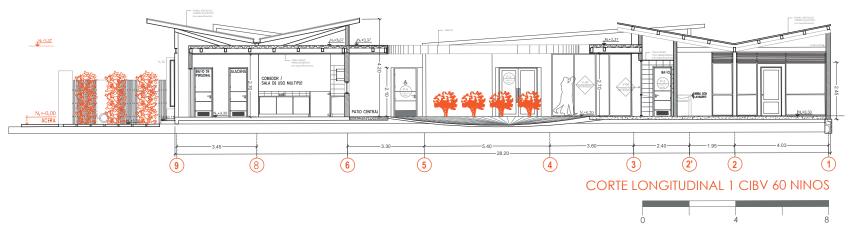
Corte Longitudinal CDI Unguí Fuente: Adaptación propia, 2025
